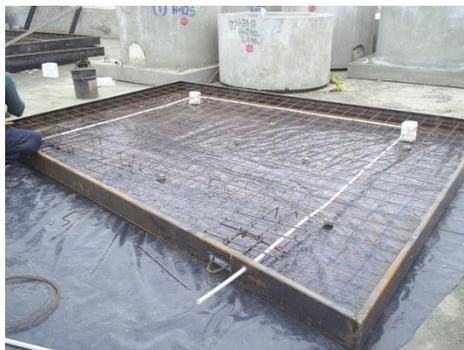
Instalación de tubo PVC eléctrica al panel
